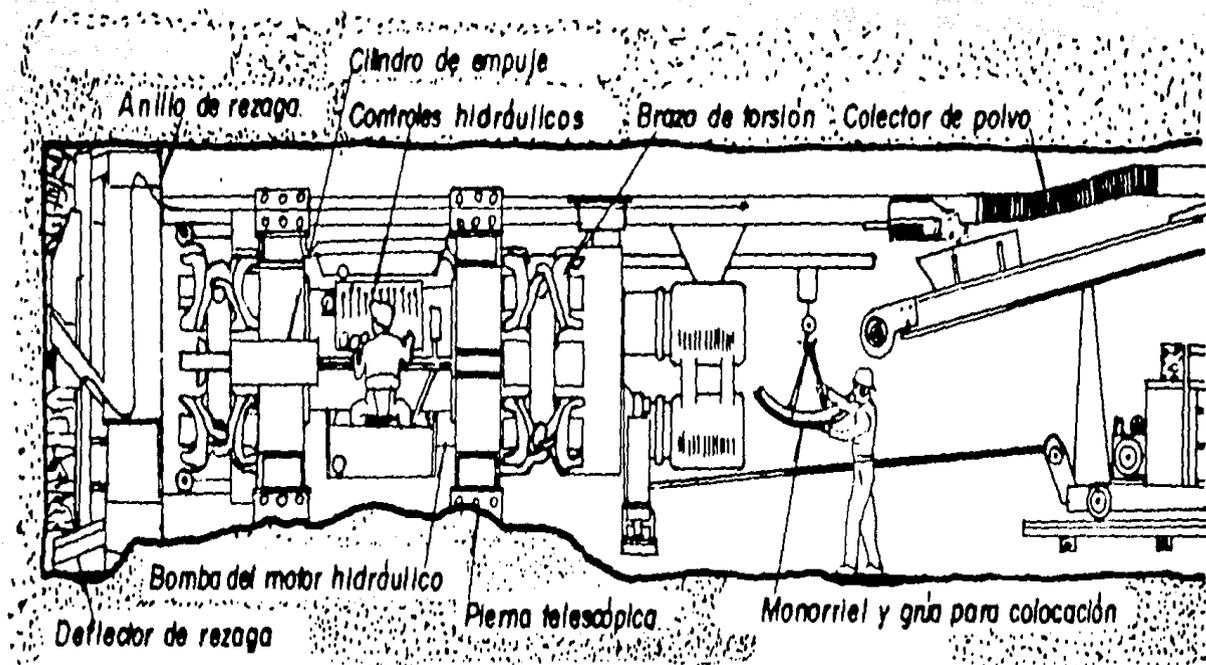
MAQUINA EXCAVADORA DE TUNEL EN ROCA (TÓPO).
